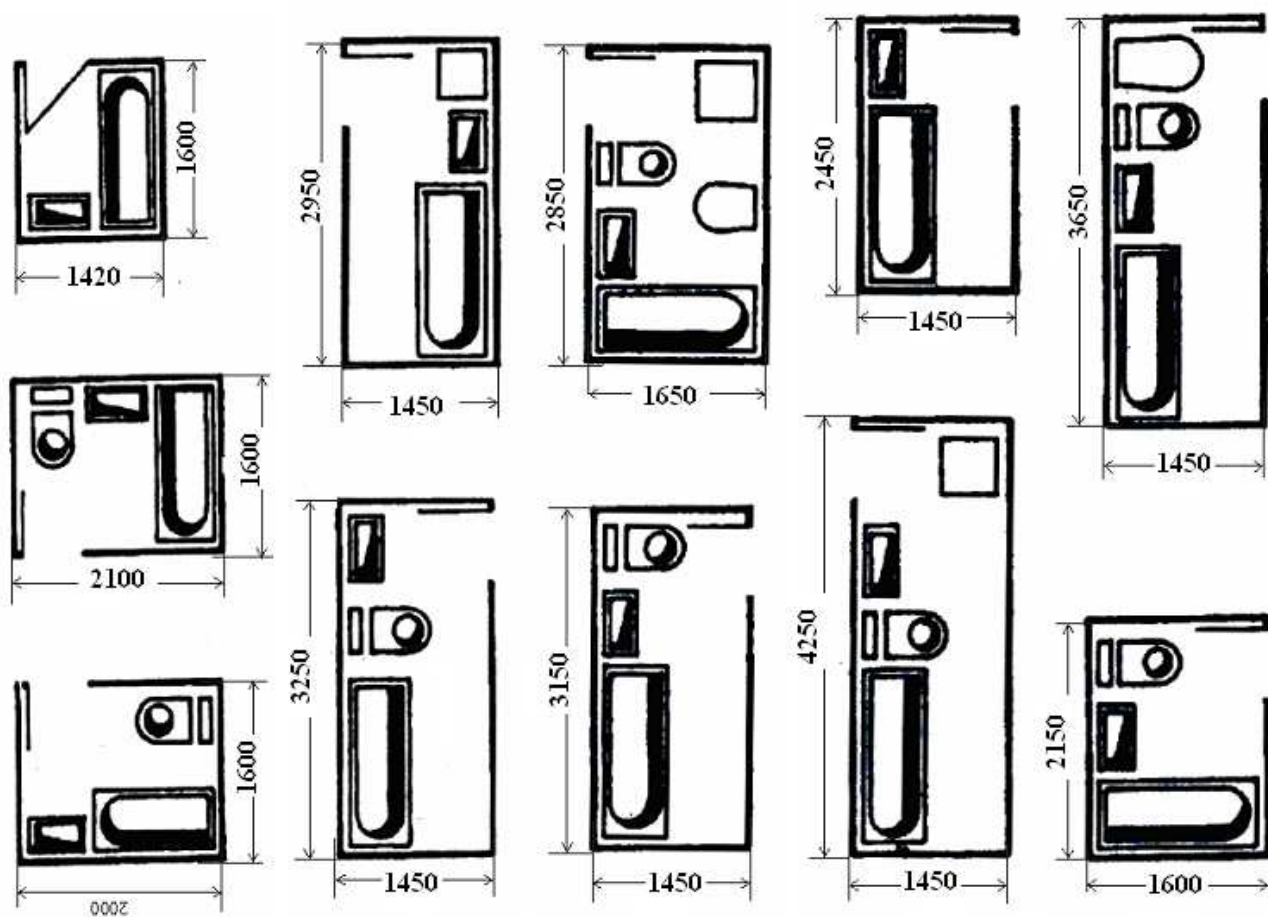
Планировочные решения ванн и совмещенных санузлов.
